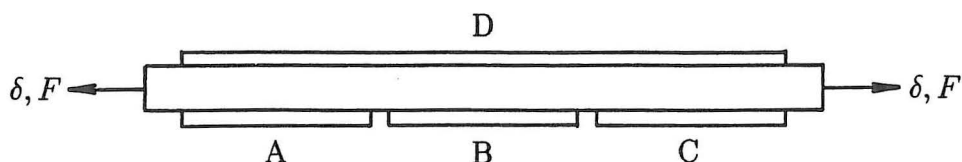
Betonstang påvirket af en deformationsstyret trækraft, [17].
